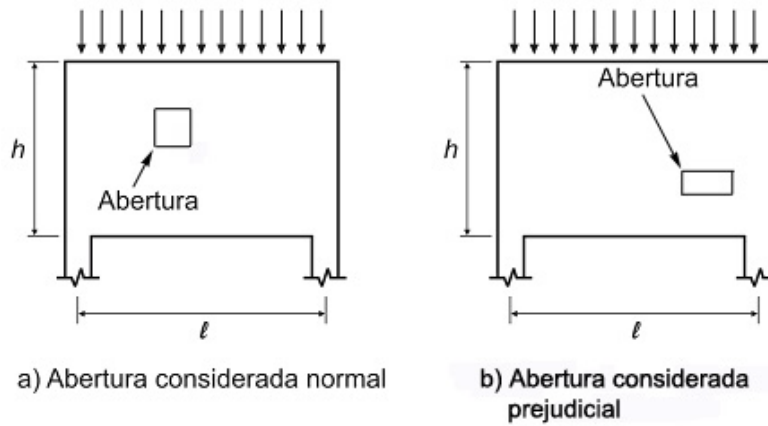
Aberturas em vigas-parede de concreto armado
